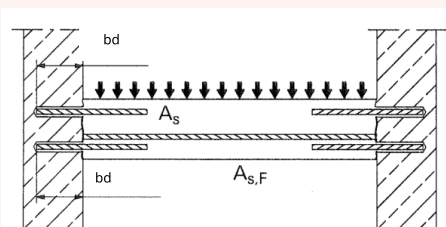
Conexión de barras de refuerzo para componentes tensionados principalmente en compresión. Las barras de refuerzo están tensionadas en compresión.
